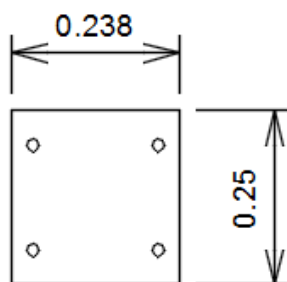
Chapa metálica pertencente ao sistema de confinamento
